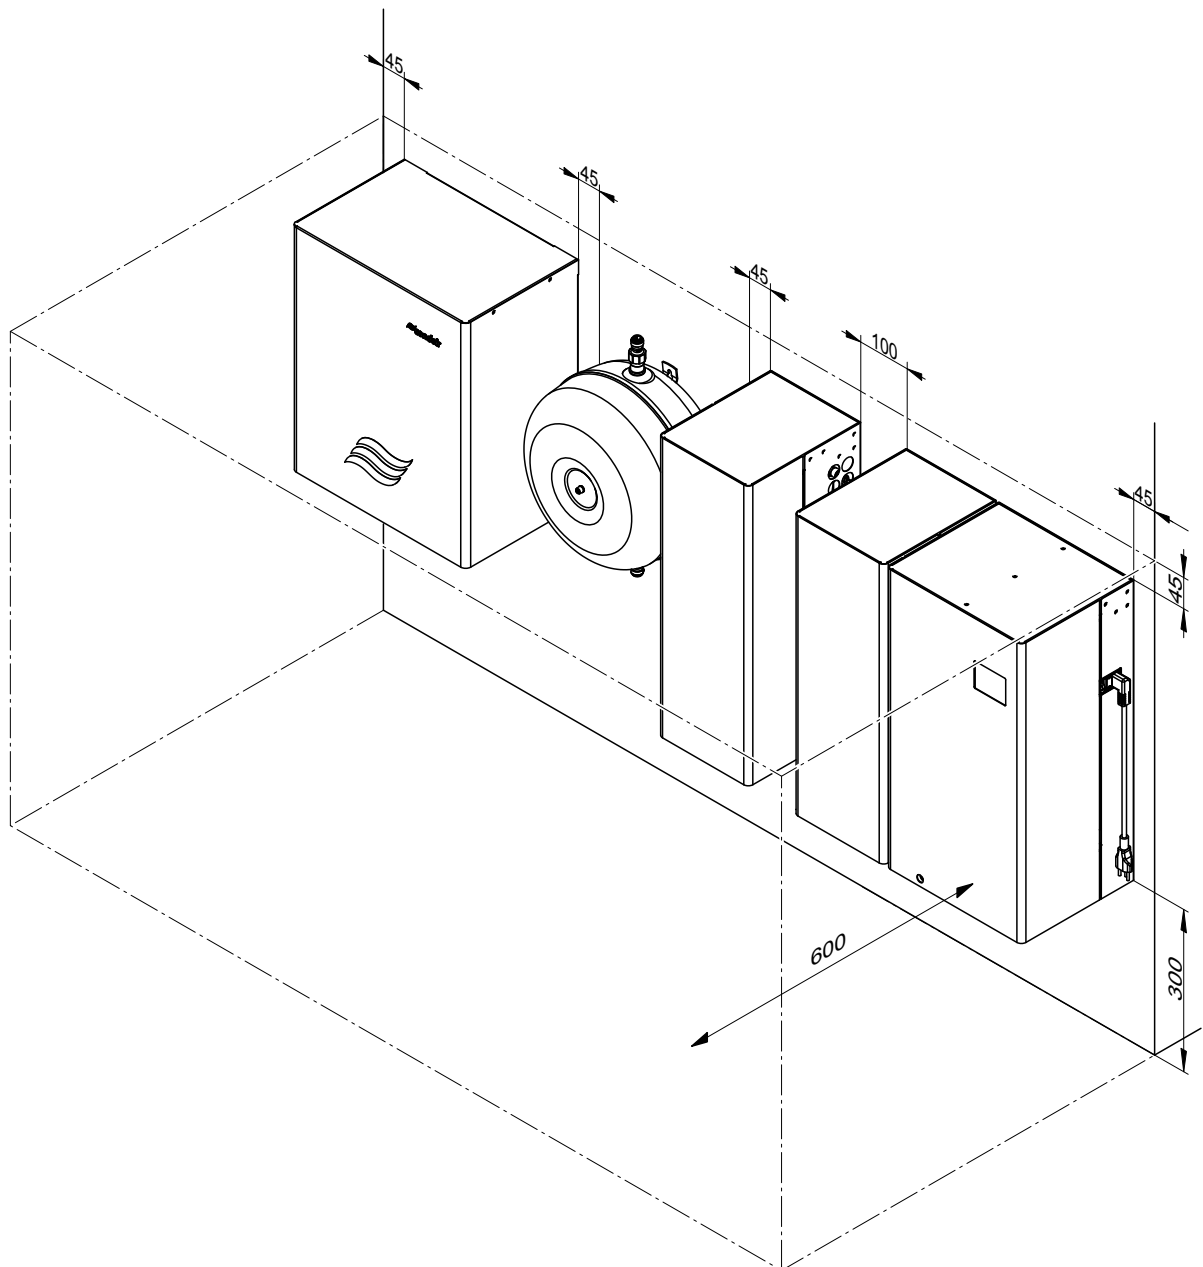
Übersicht einzuhaltende Abstände (Masse in mm)
